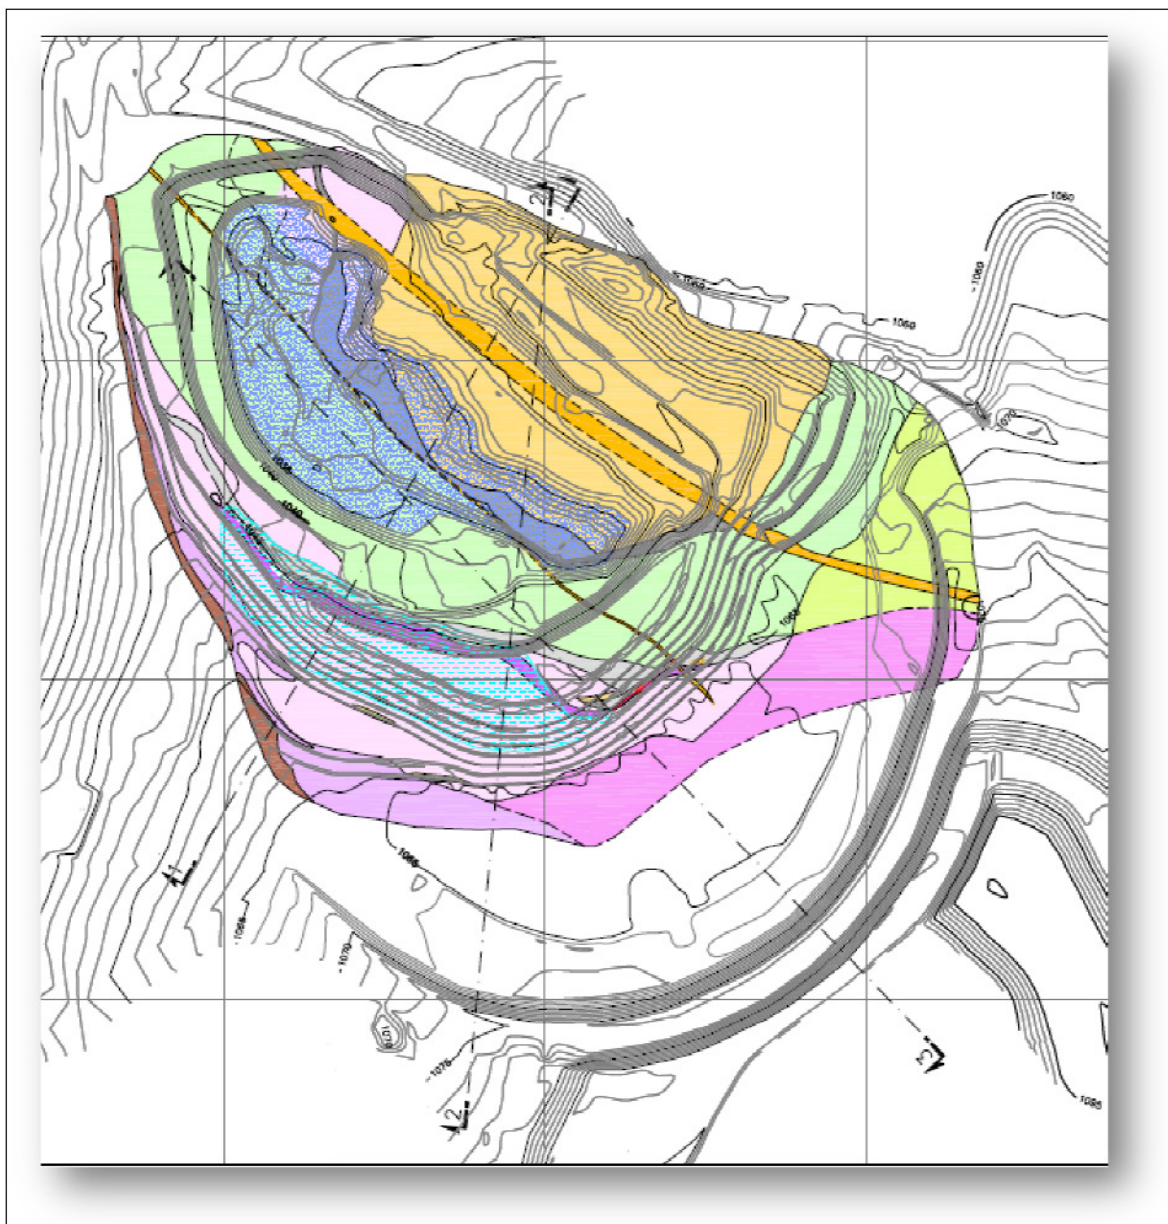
Planta esquemática com as seções utilizadas para as análises de estabilidade de taludes da mina
